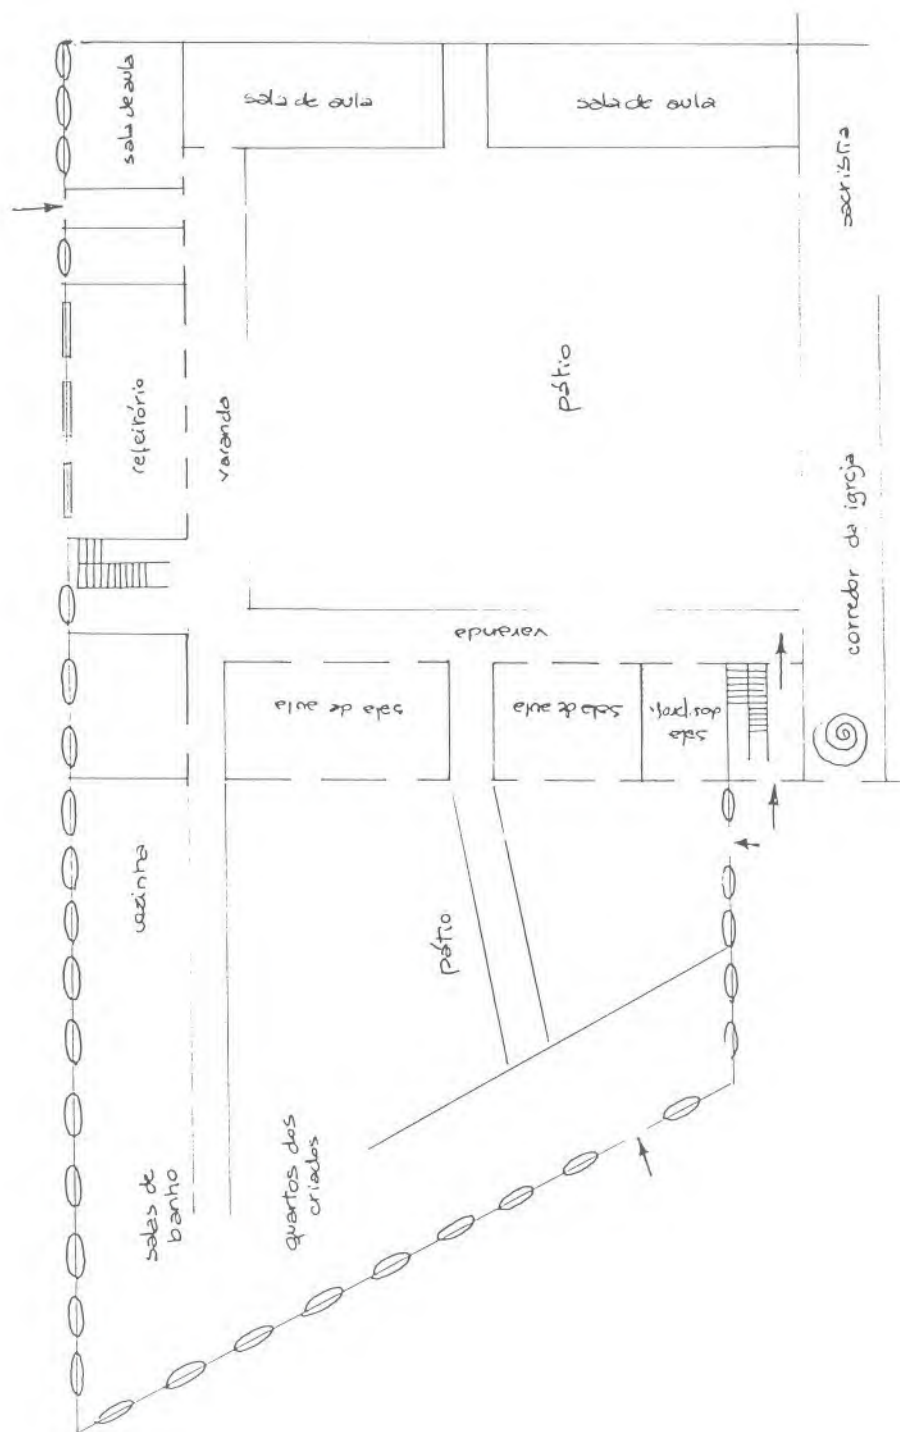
Colégio Pedro II – esquema da planta do 1º pavimento (já com elevação da parte da esquina)
